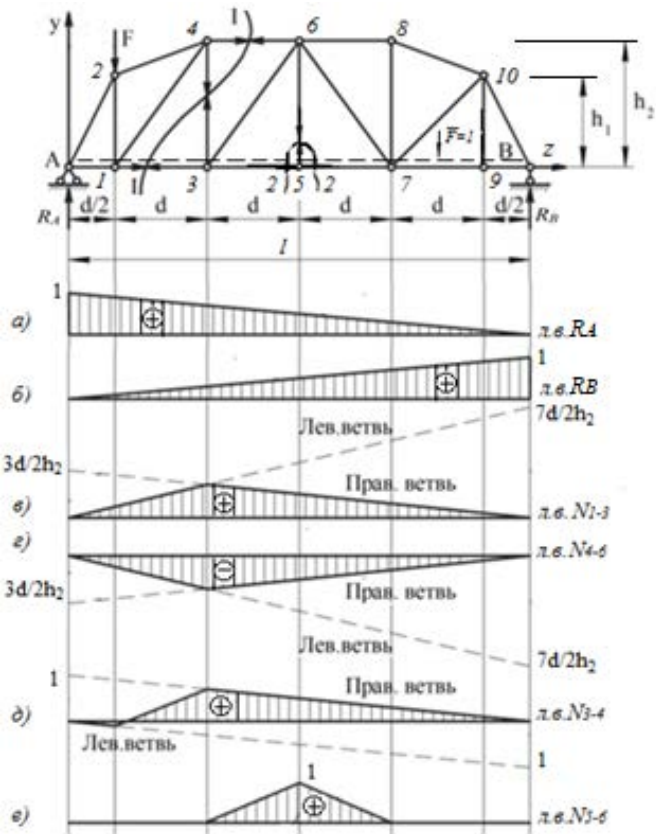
Расчетная схема однопролетной фермы с простой решеткой
